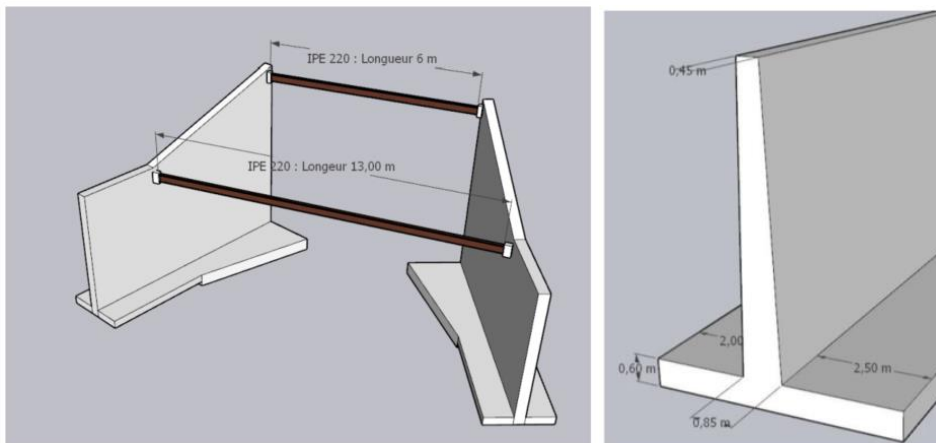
A gauche, schéma de positionnement des butons, à droite, coupe type du mur en T projeté pour remplacer les bajoyers (ARTELIA, 2022)
